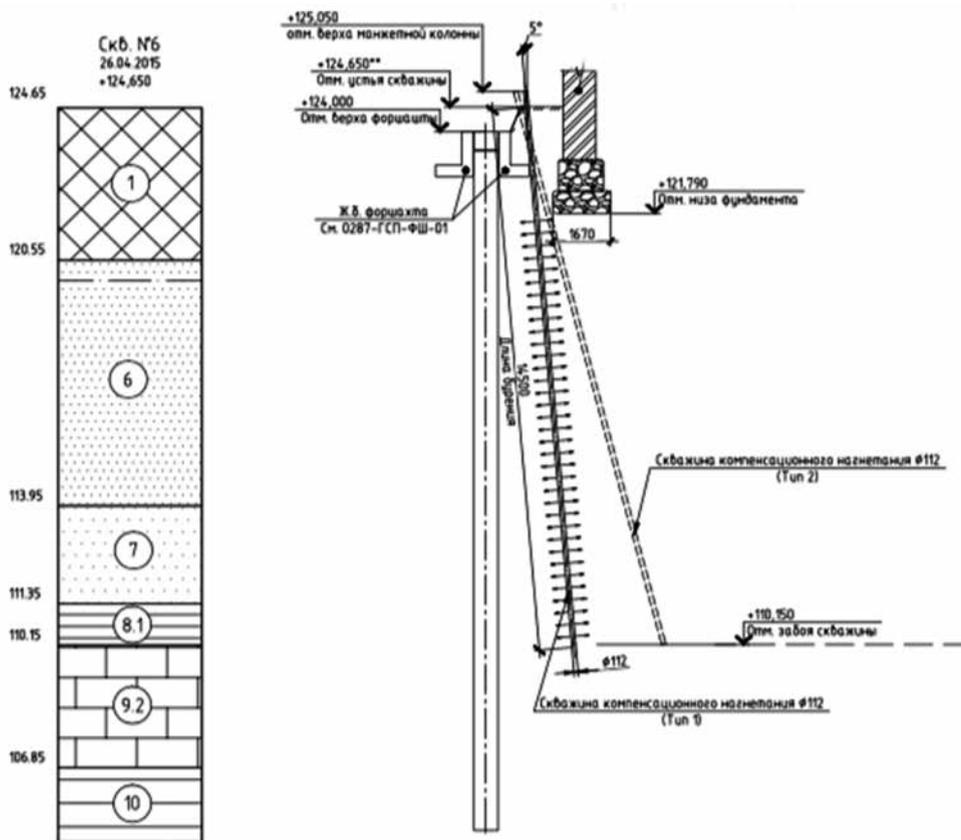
Схема выполнения работ по усилению грунтового основания фундаментов существующих зданий
